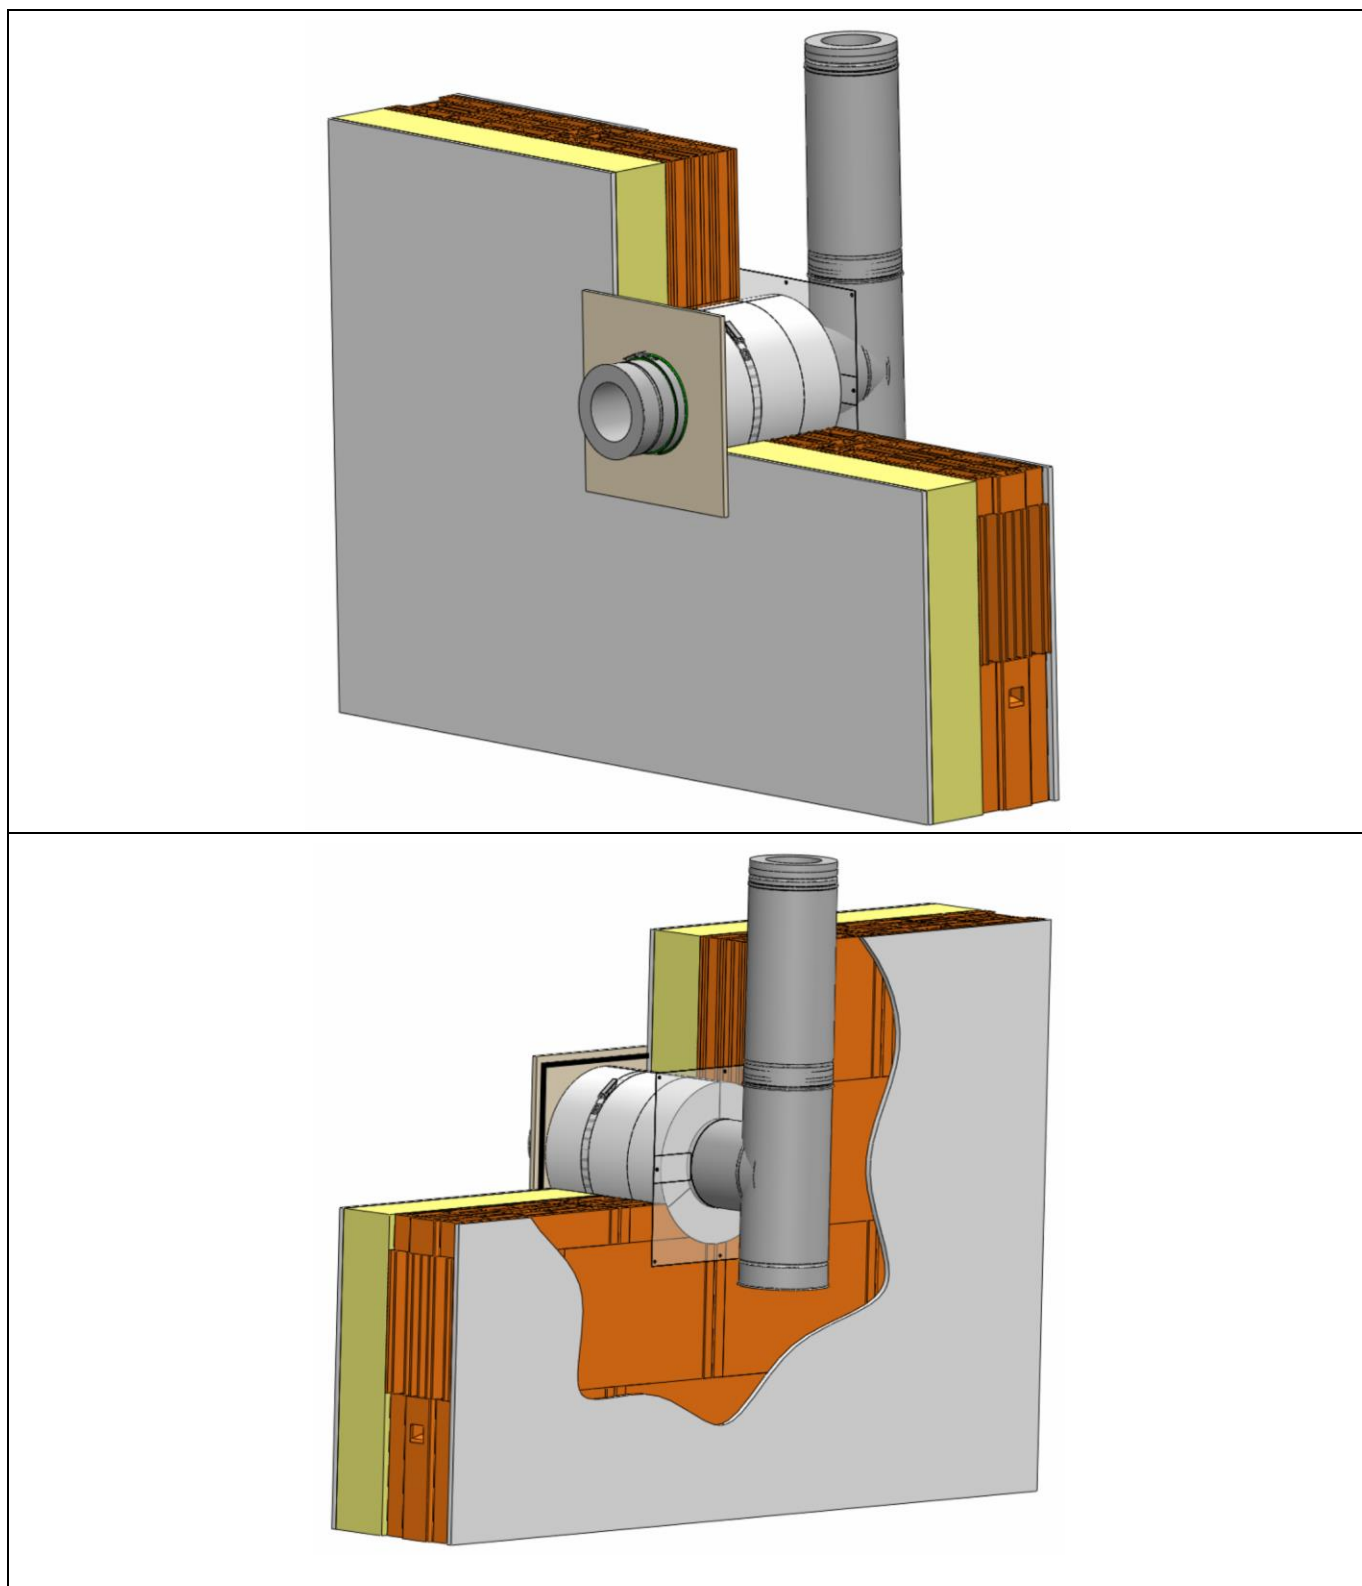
Schéma de mise en œuvre en traversée de paroi verticale (sortie murale)
